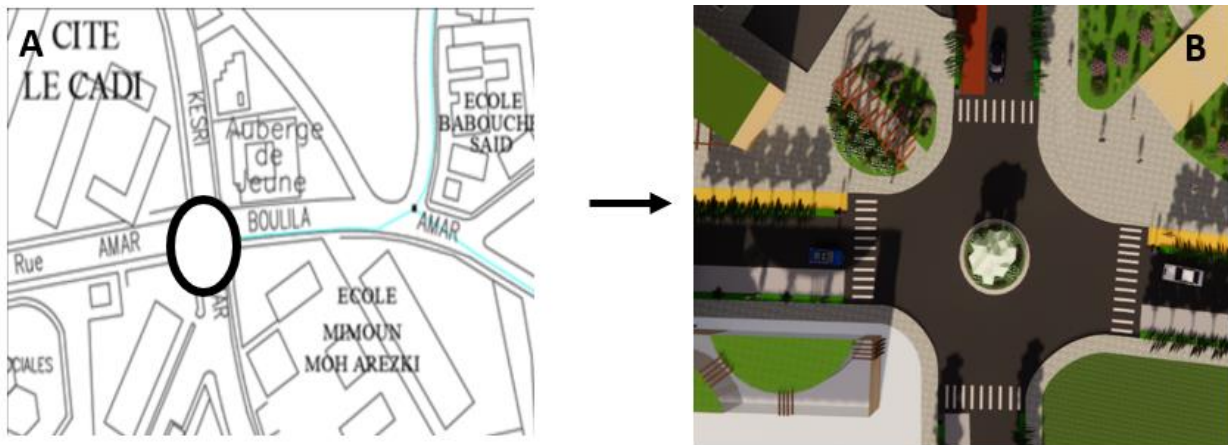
48 : vue en plan de l'intersection avant et après l'intervention
